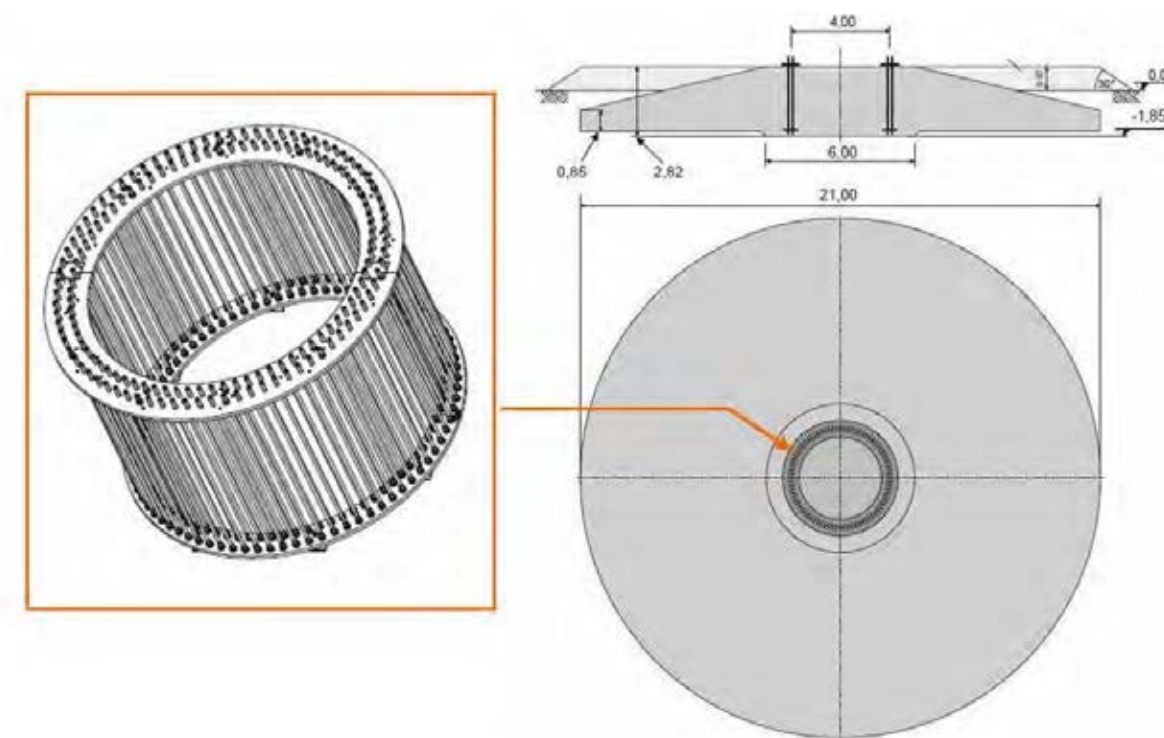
Schéma d'une fondation et de l'« anchor cage »
